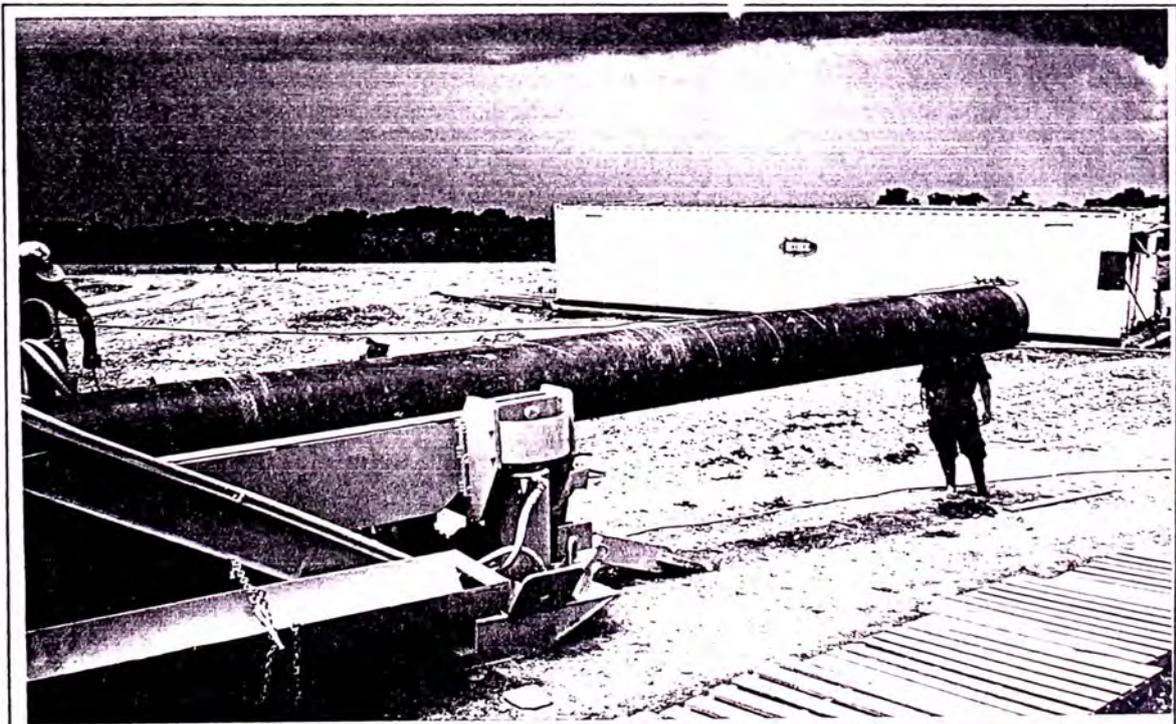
Posicionado de tubo para doblado a razón de 1° por pie de tubería.
